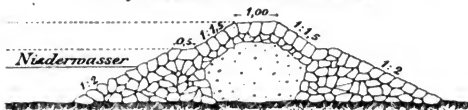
Leitwerk aus Packfaschinen mit abgeplasterter Krone und einer Grundböschung aus Steinwurf.
